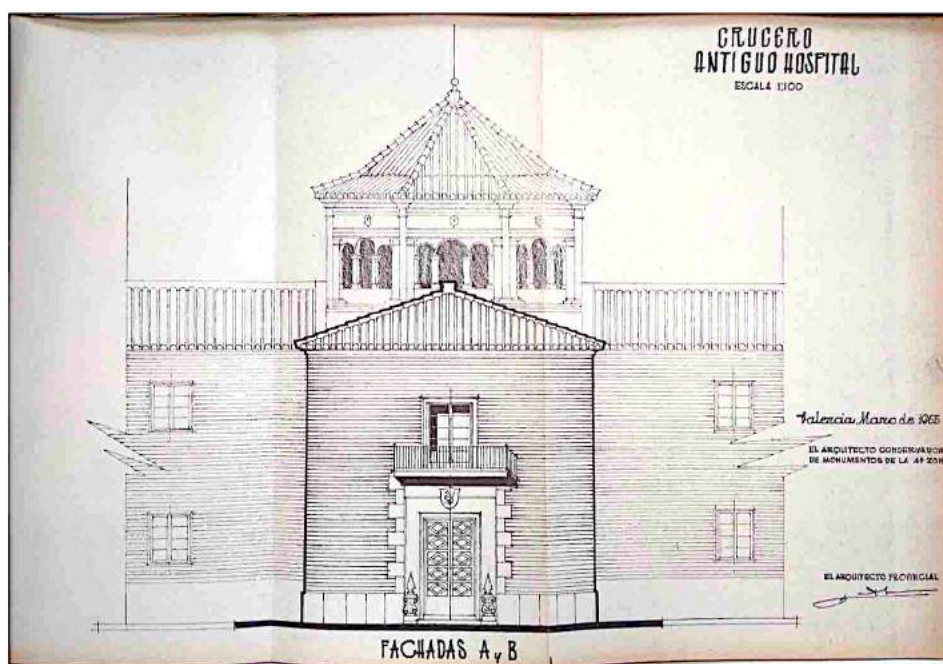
Proyecto de restauración del crucero primitivo del antiguo Hospital. 1ª fase, 1965. Fuente: A.D.P.V./ Fondo Diputación, E. 14.02, Caja 6196
